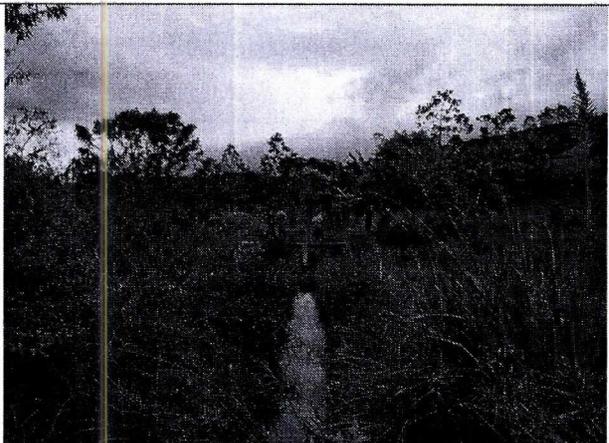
Puente de madera existente y punto donde se proyecta construcción de box culvert.
